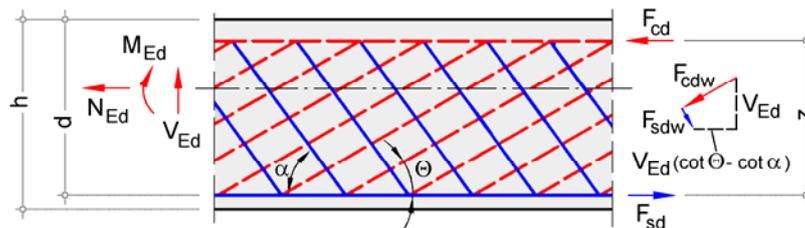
DIN FB 102, 4.3.2.4.2, Abb. 4.13: Fachwerkmodell für querkraftbewehrte Bauteile
